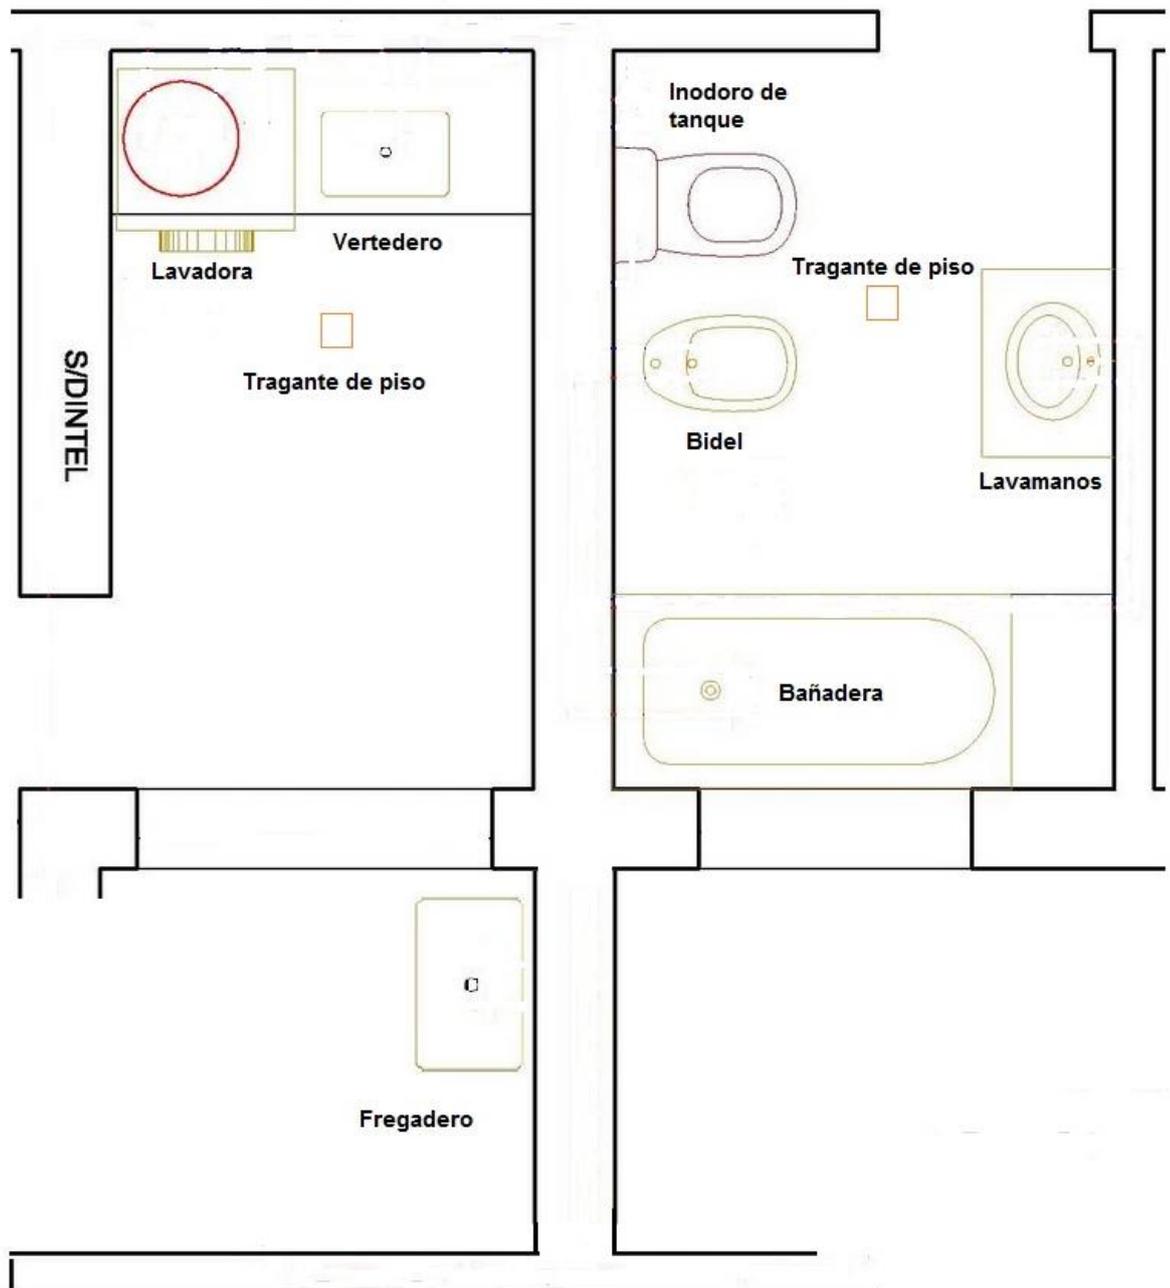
Vista en planta del espacio sanitario de un apartamento
